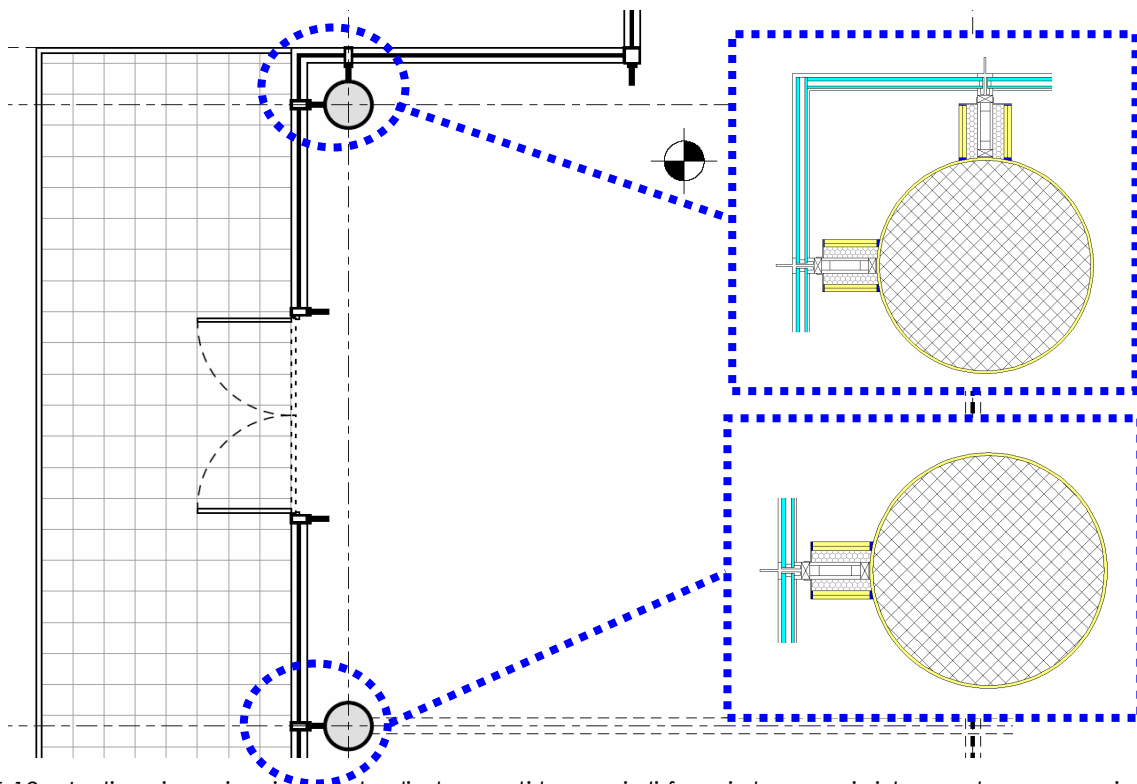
Indicazione in pianta degli elementi leggeri di facciata non rigidamente connessi
